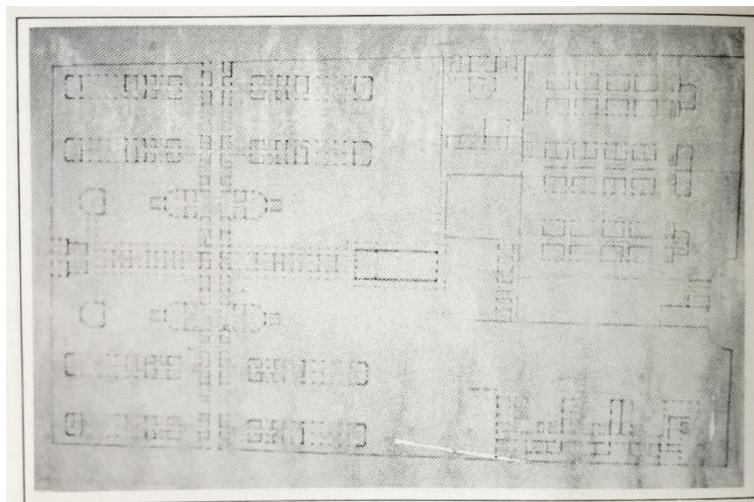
Hospital de San José. Plano de la planta general. Elaborado por Pietro Cantini, 1904. Fuente: Cantini, J. (1990). Pietro Cantini, Semblanza de un Arquitecto. Editorial Presencia, Bogotá. (p.282)
